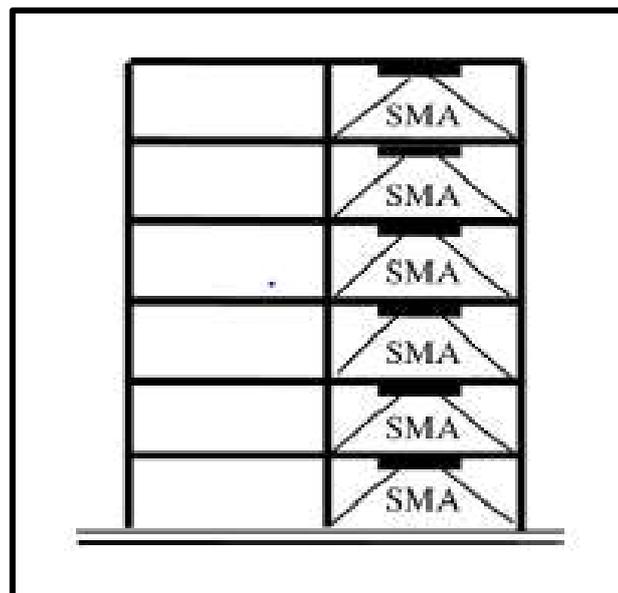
Schéma d'installation des bretelles en AMF pour la prévention sismique (Source : Adoum Waibaye.2016)
